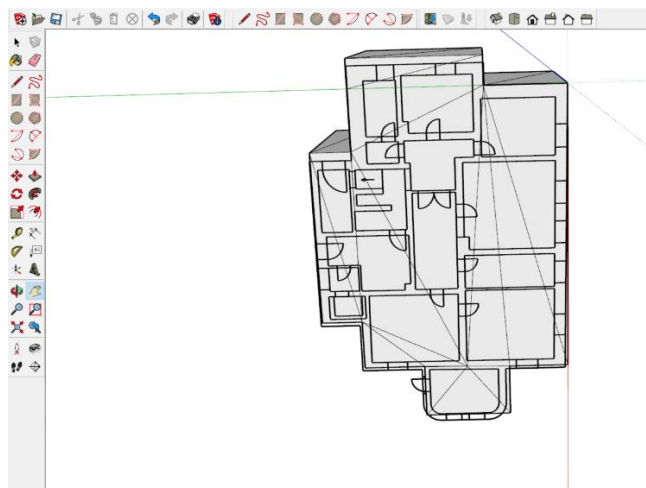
Einpassung der Grundrisse (Eigene Darstellung 2018)
